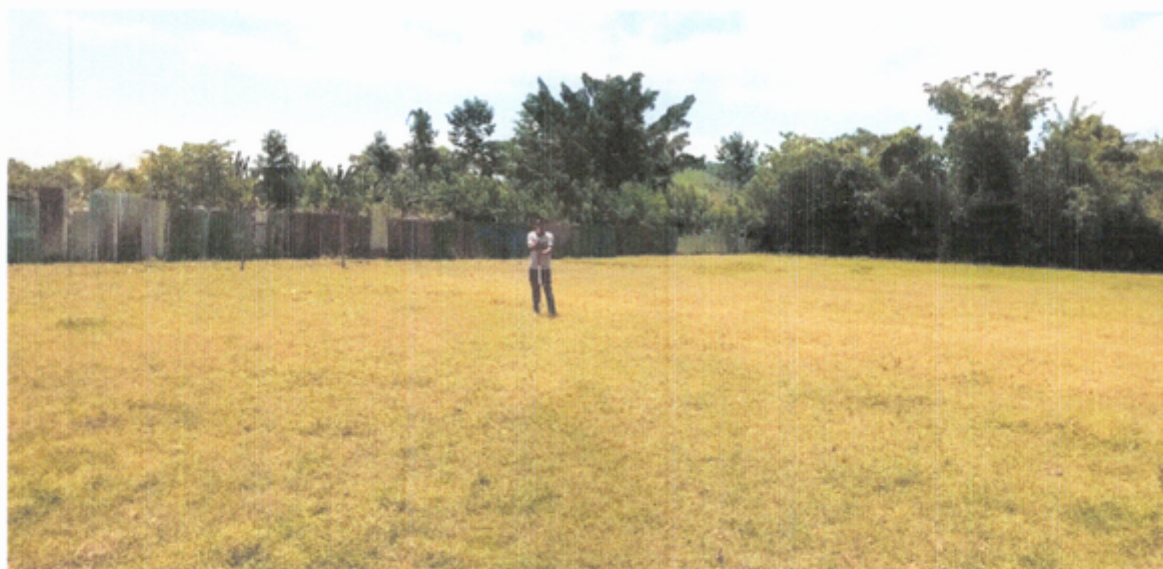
y 2- Vista en la proyección de losa deportiva techada.
